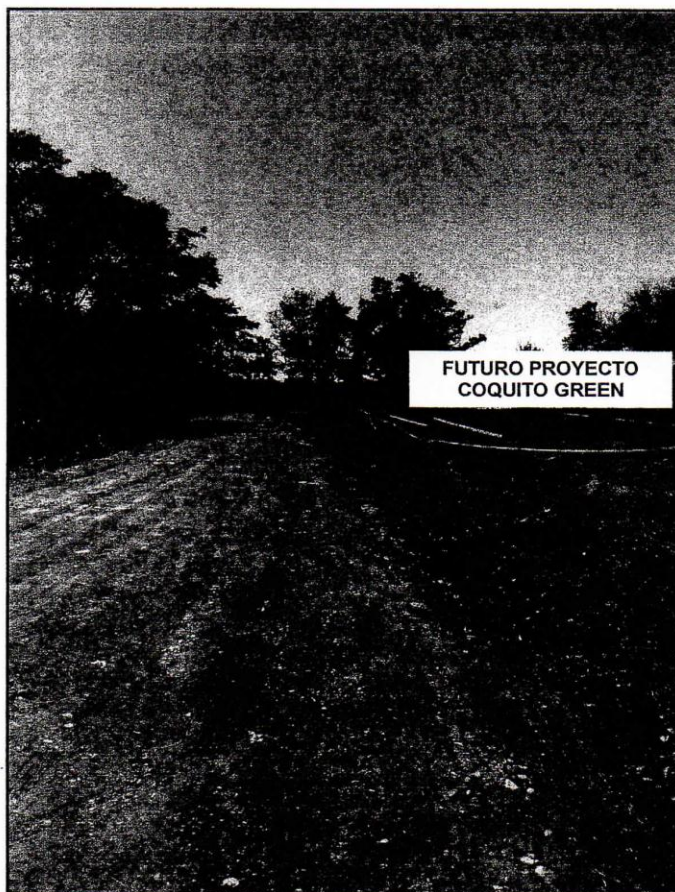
CALLE DE TIERRA EXISTENTE QUE COLINDA CON EL GLOBO DE TERRENO DONDE SE DESARROLLARÁ EL PROYECTO DE VIVIENDAS COQUITO GREEN.
